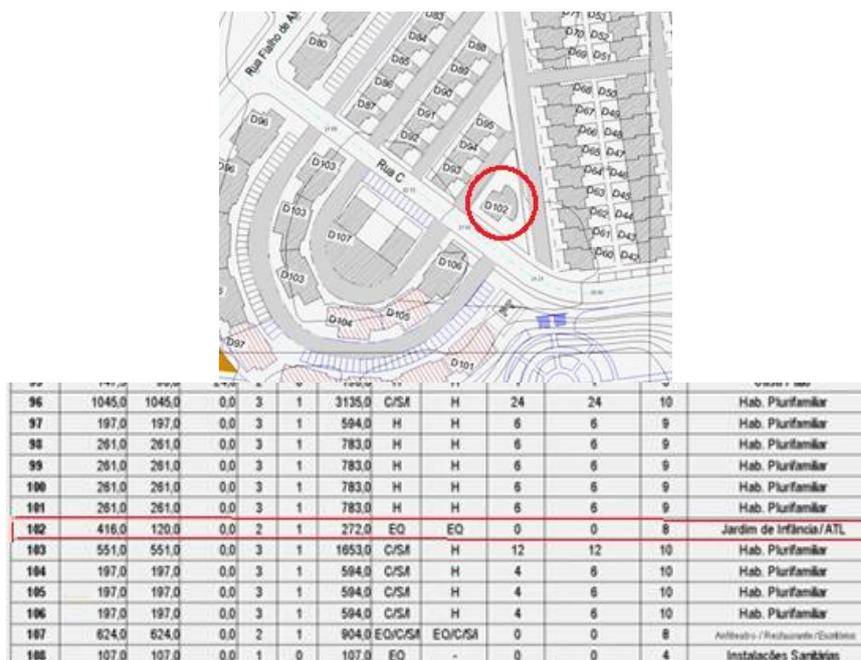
Extrato da Planta de Implantação e respetiva legenda.
